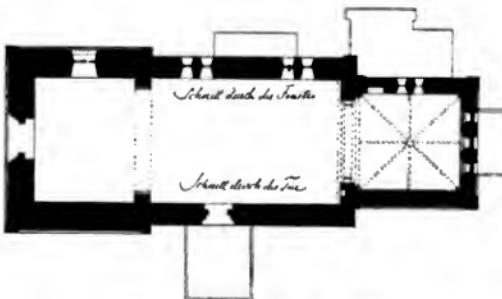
Grundriss der Kirche. 1:60.
